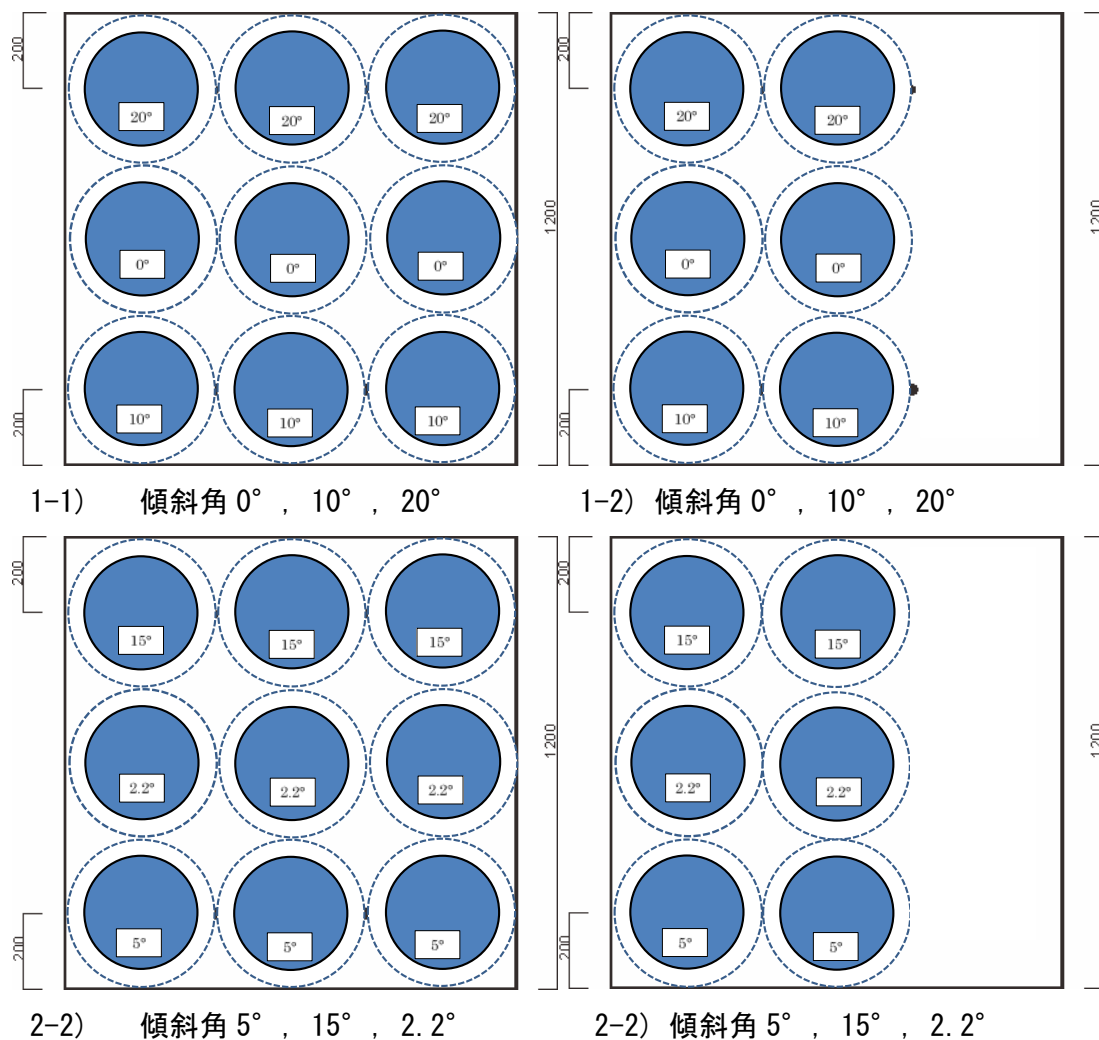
引張実験用の試験体形状とアンカー筋の配置状況
